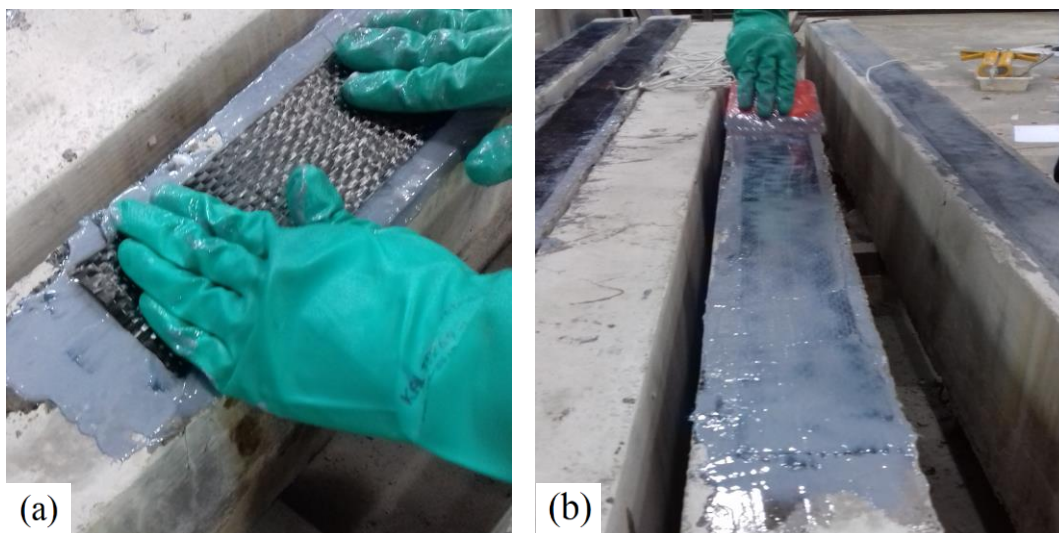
Aplicação do adesivo sobre o substrato de concreto
